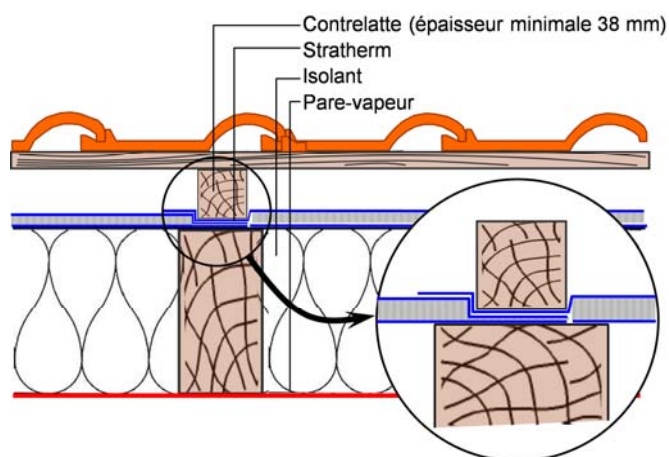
Recouvrement en about de lè sur support discontinu
